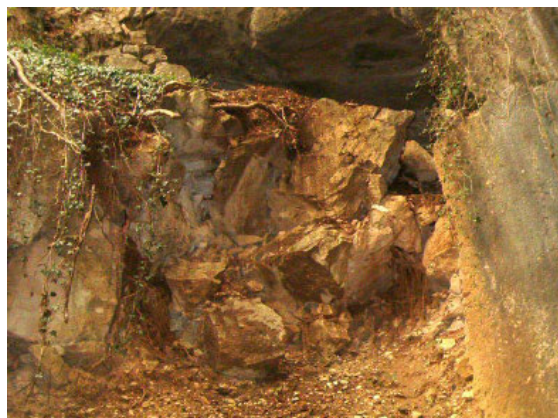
Ammasso roccioso fratturato ad W pilastro n. 32 dal quale si sono staccati vari blocchi rotolati fino alla pista di accesso.
